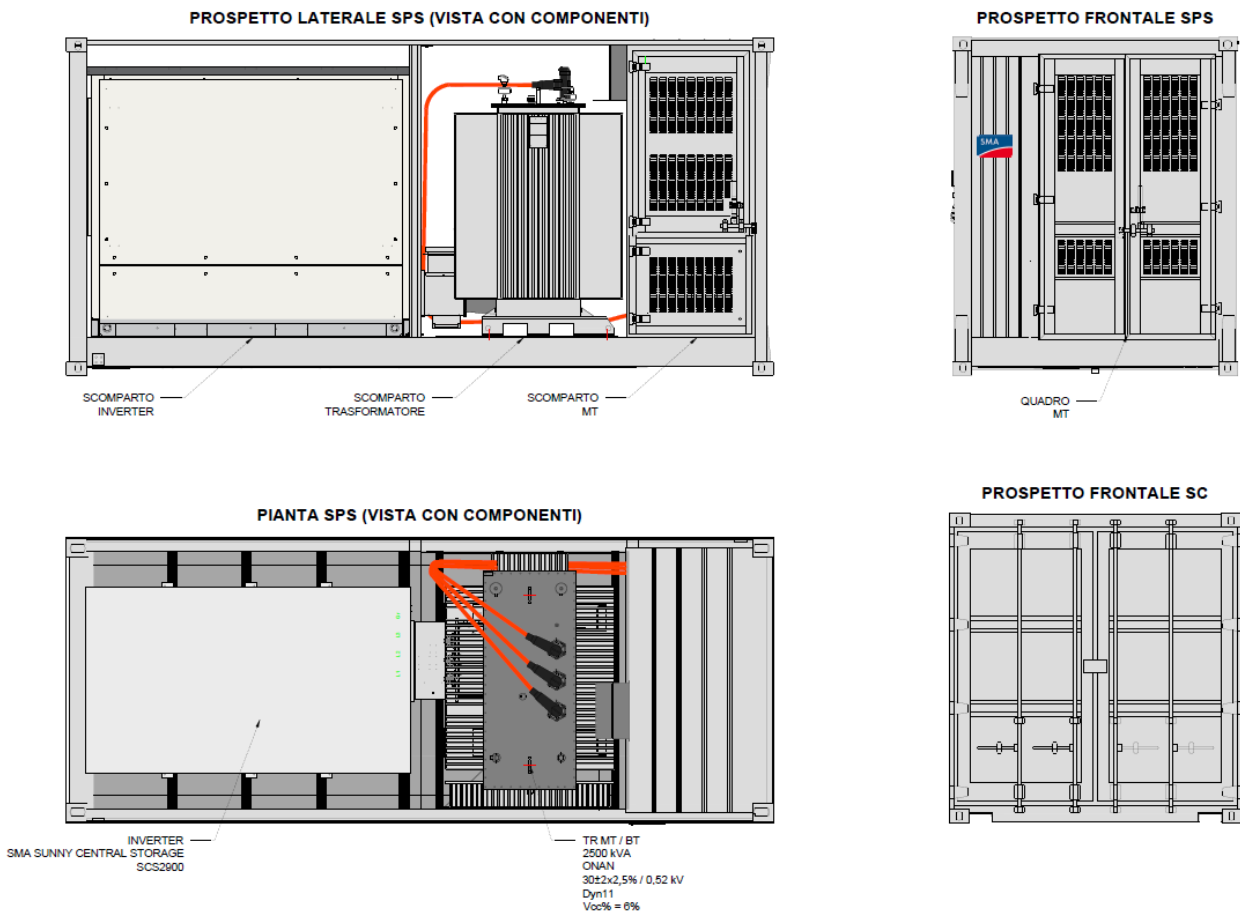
Pianta e Prospetto dello Storage Power Station con Storage Inverter
